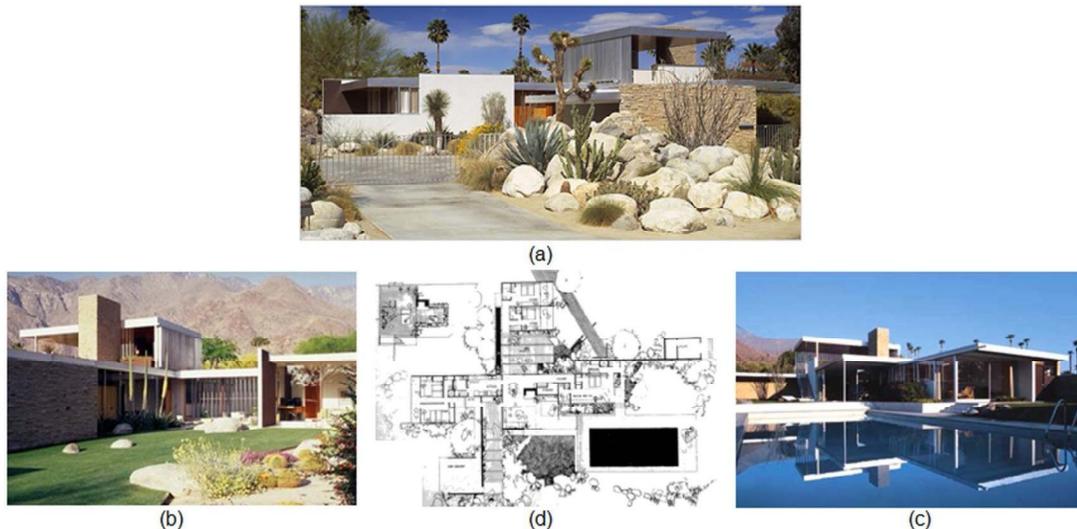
Richard Neutra, Casa Kauffman, Palm Springs, California, E.U.A (1946): (a) Vista exterior acceso de la residencia, (b) Vista exterior desde el jardín, (c) Vista exterior desde la alberca, (d) Planta arquitectónica.
